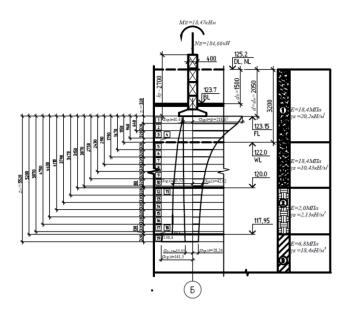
Расчетная схема для определения осадки к примеру 8.3
